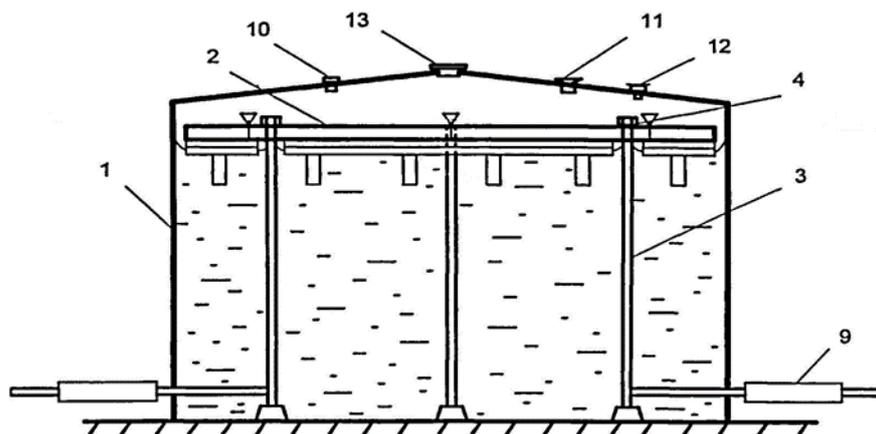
Вертикальный резервуар с плавающей крышкой или понтоном: 1 – резервуар; 2 – плавающая крышка или понтон; 3 – направляющая стойка; 4 – заглушка; 9 – пускозапорное устройство; 10 – дыхательный клапан; 11 – световой люк; 12 – замерной люк; 13 – вентиляционный патрубок
